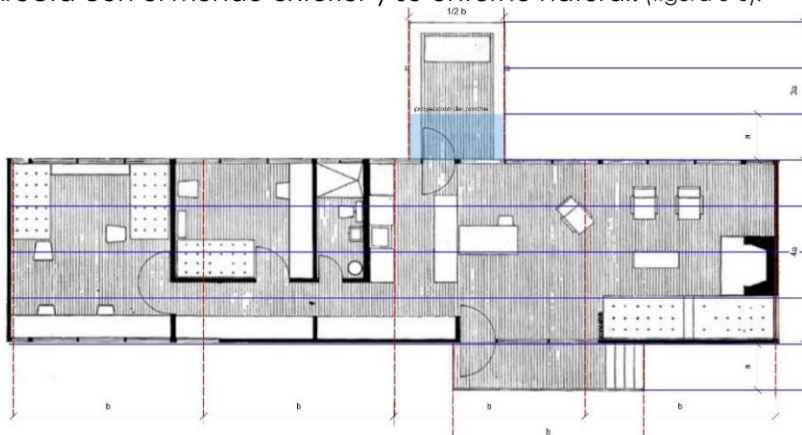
Planta del prototipo para Cape Cod, publicada en 1946. Fuente: Autor.
